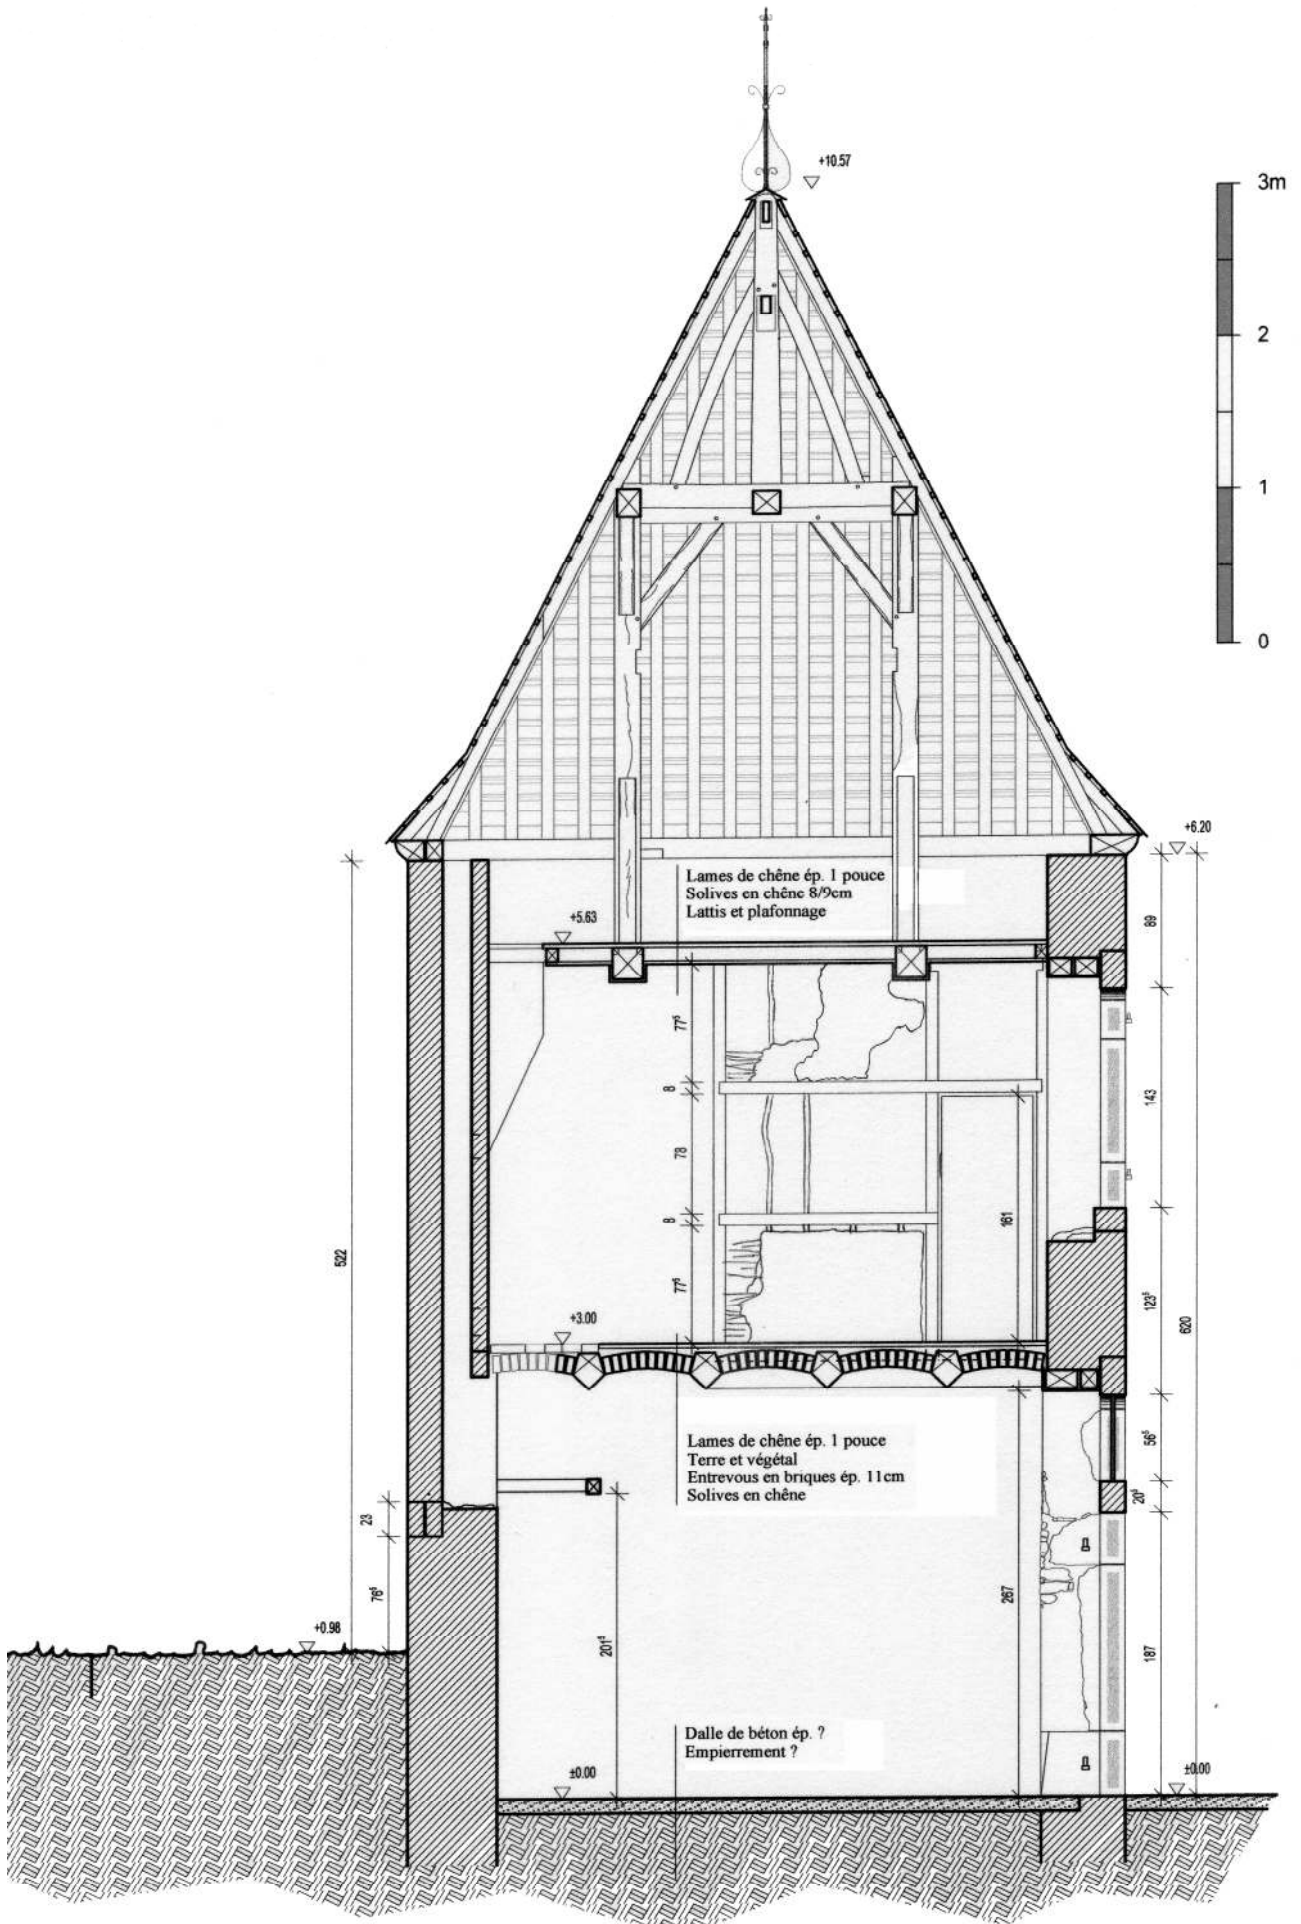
Pavillon. Vue en coupe BB'. Ech. 1/50°. Situation existante. IG 2003.
